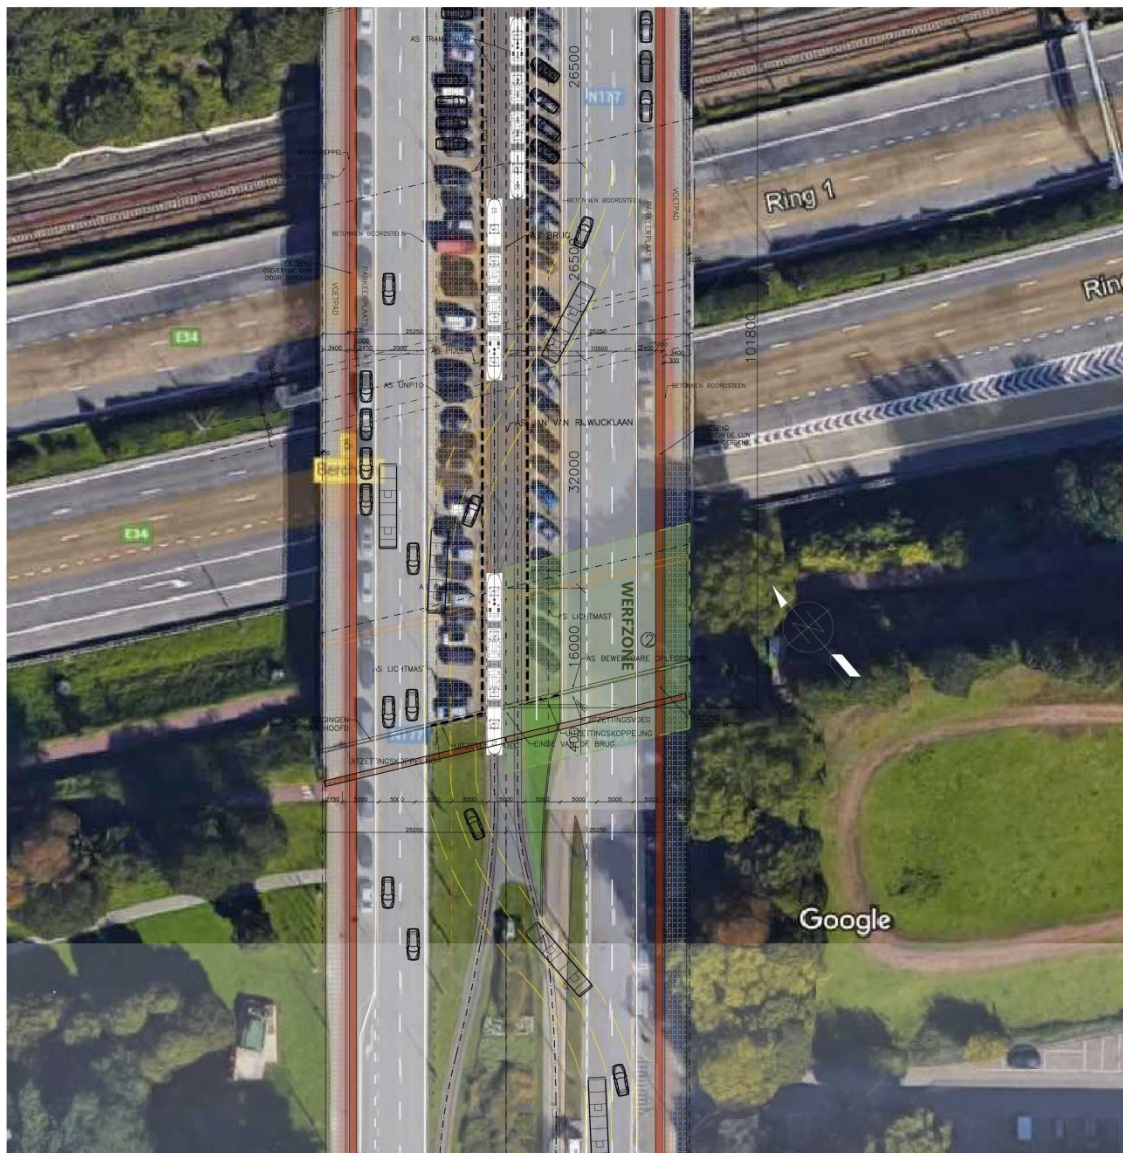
bovenzicht brug Jan van Rijswijk fase 2: uitvoering wand zijde richting centrum, alle verkeer over 1 zijde (richting periferie)
